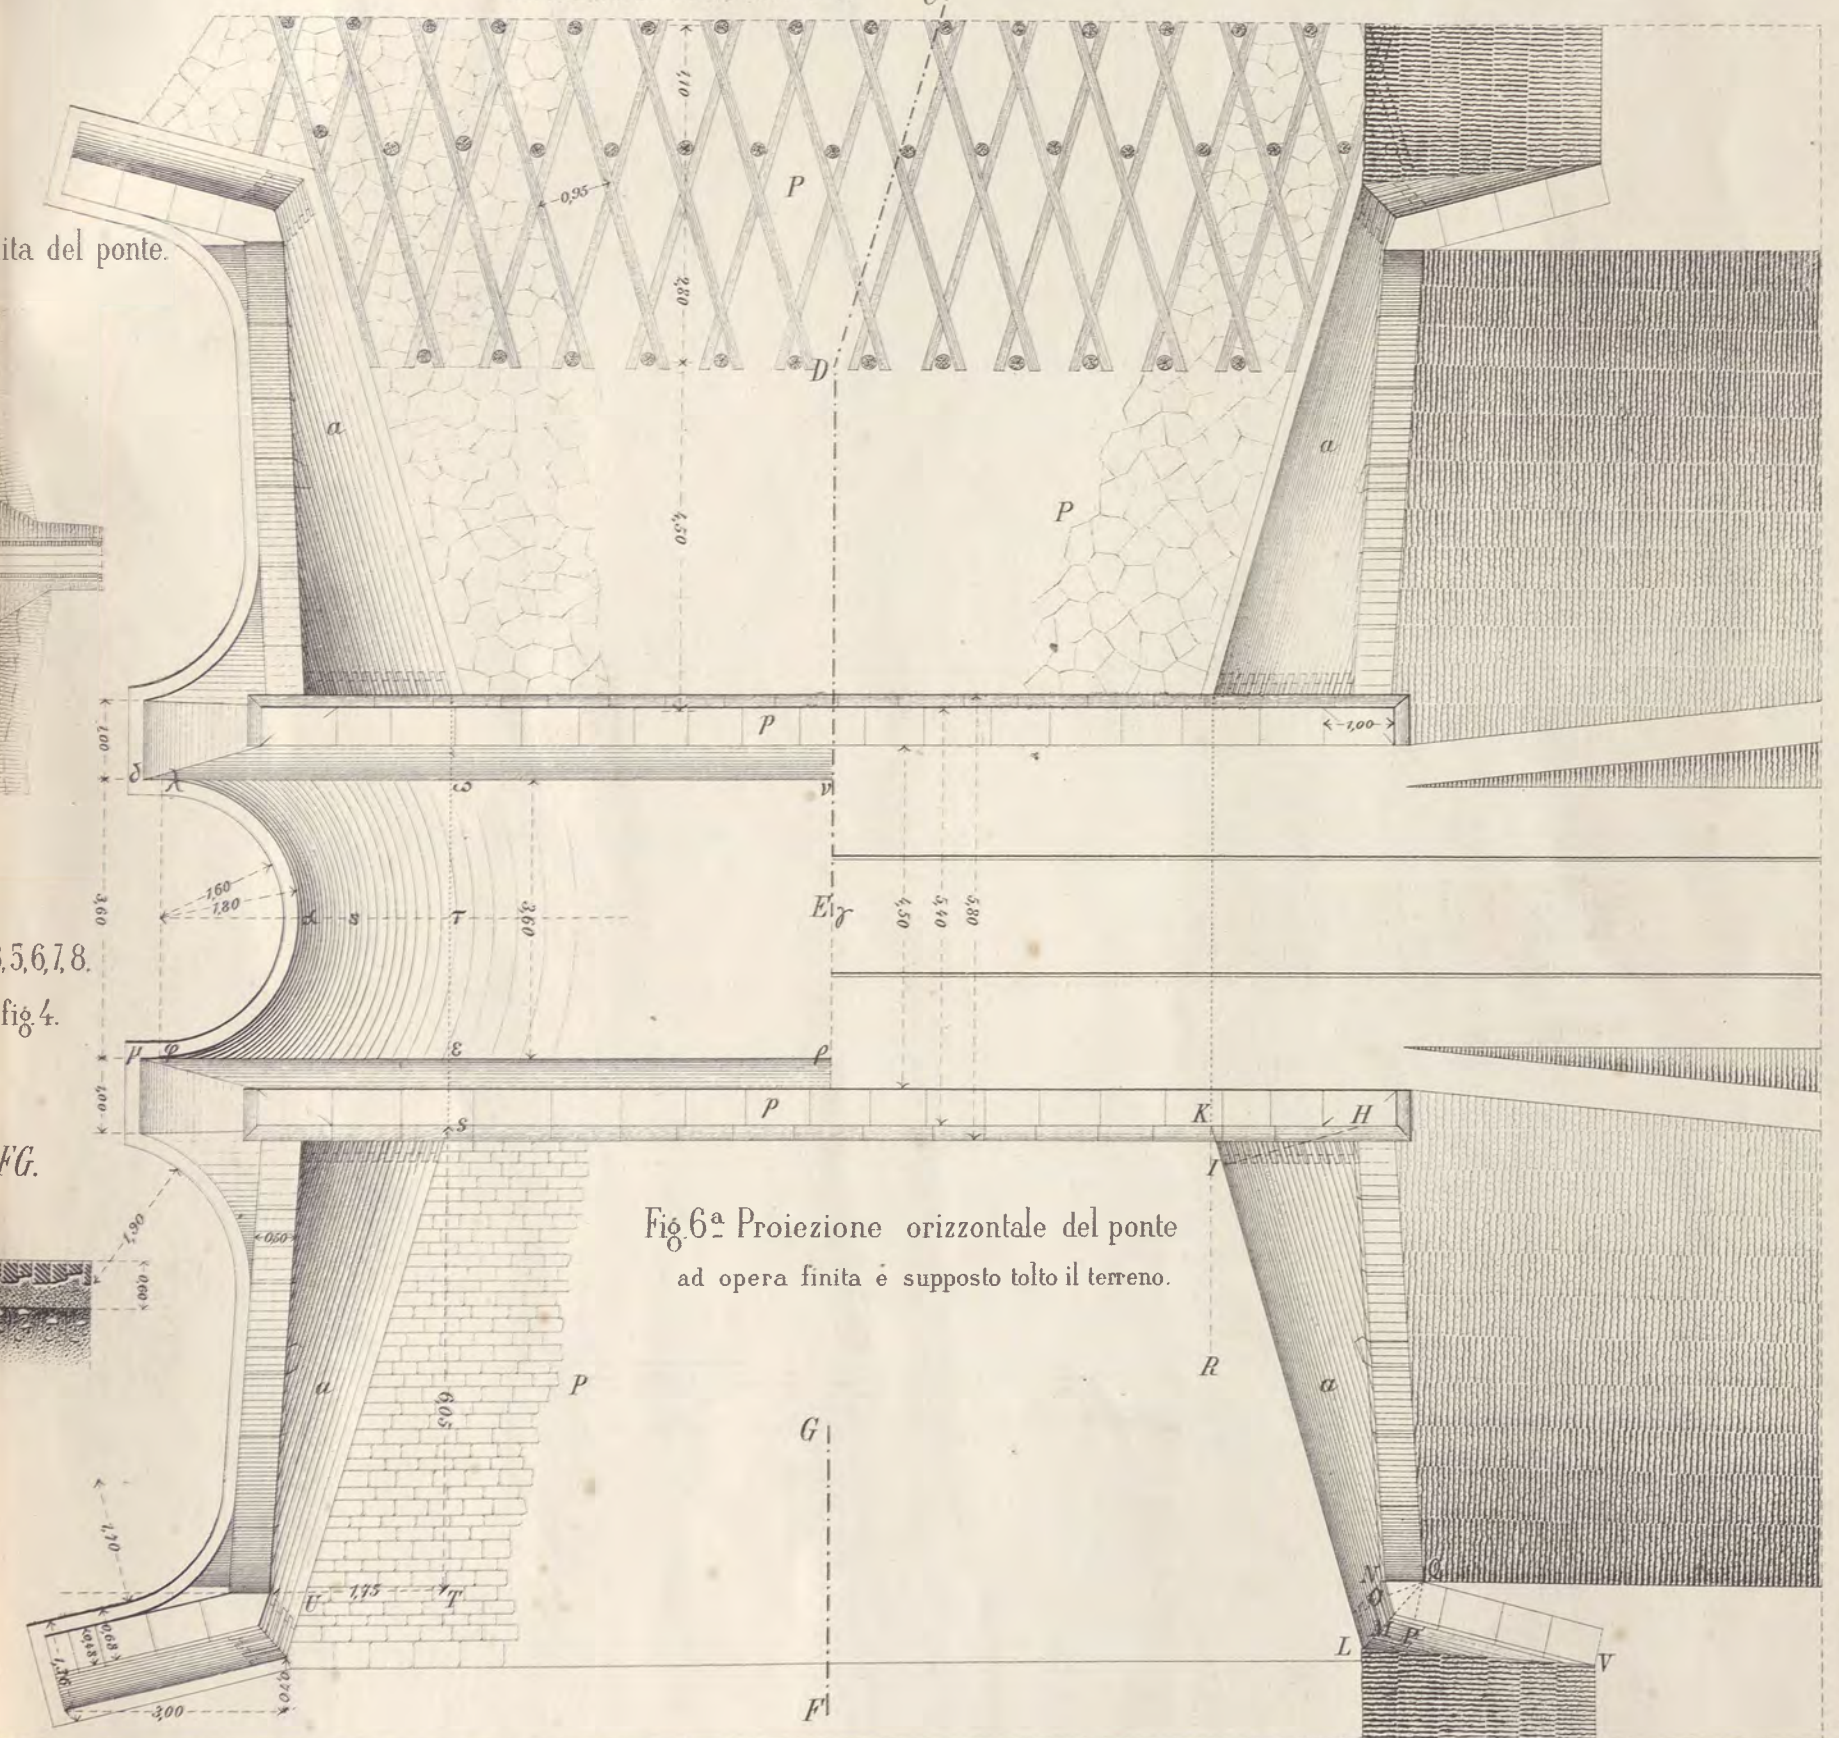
<sup>a</sup> Proiezione orizzontale del ponte ad opera finita e supposto tolto il terreno.
